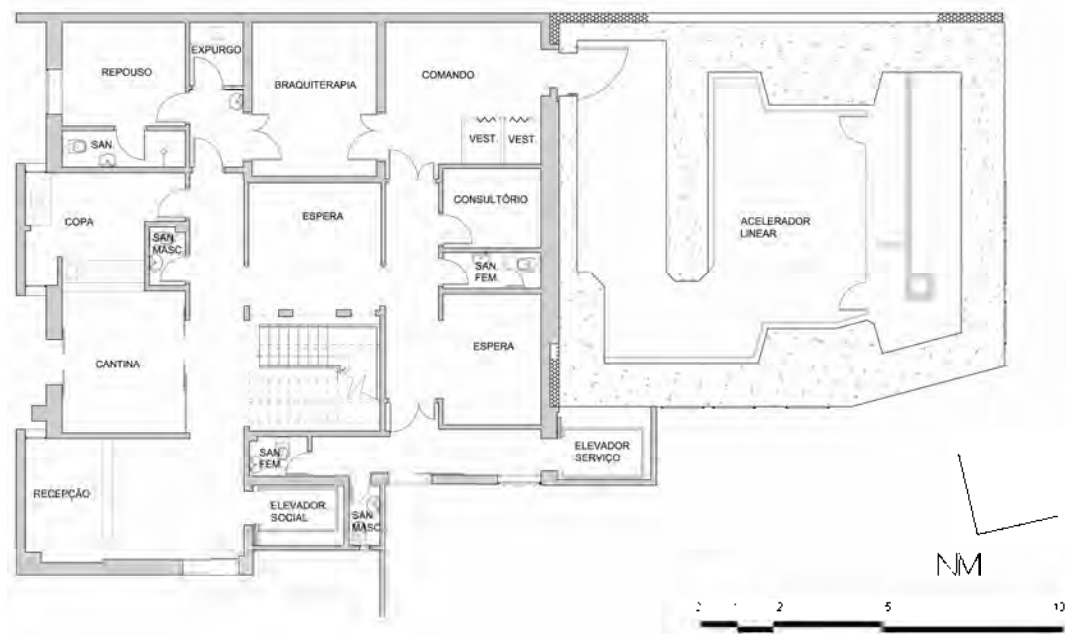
Planta – pavimento térreo conforme zoneamento Z13.
